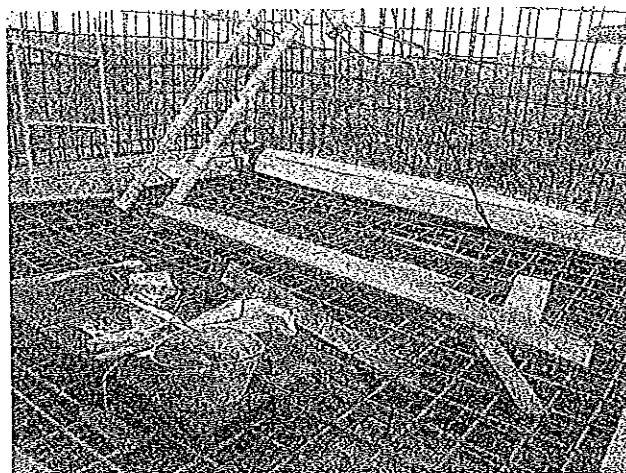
parrillas instaladas para la fundida de la placa inferior del tanque.
